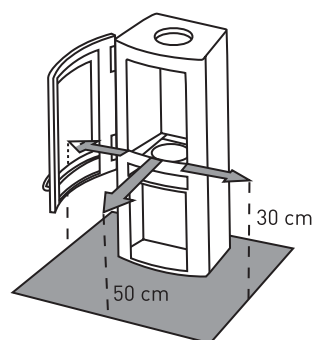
| Dimensioni della piastra di supporto per stufe caminetto
